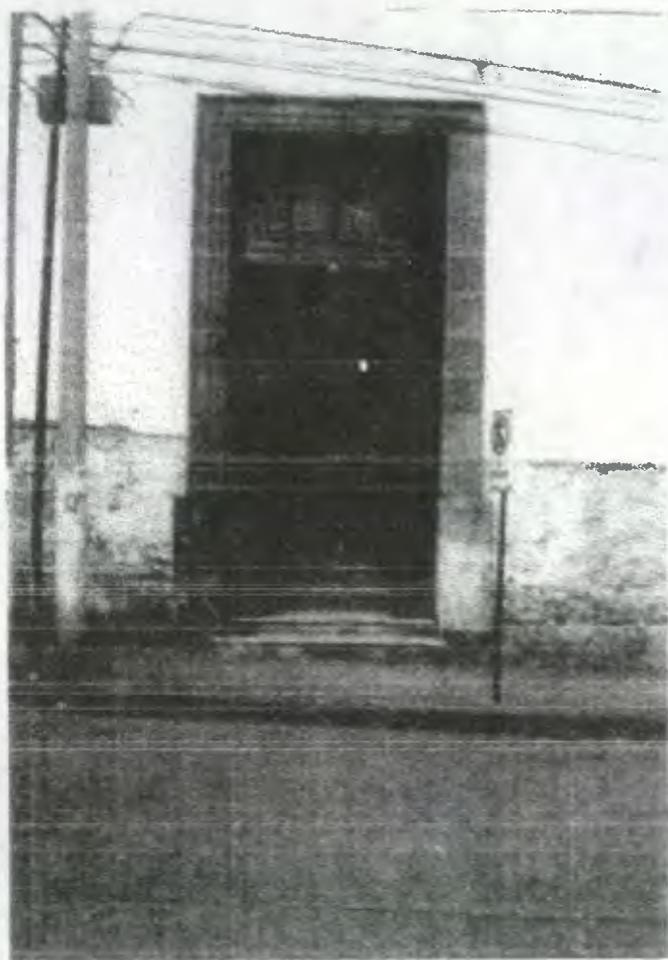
Vista del estado de deterioro que presenta el ingreso al templo por la 13ª. Calle.
